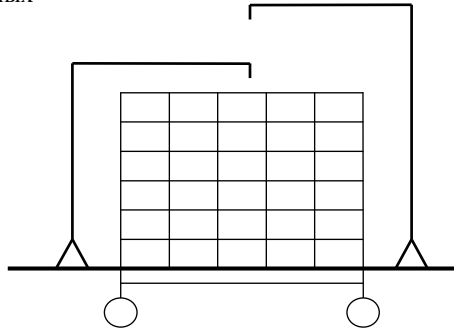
Схемы расположения монтажных кранов (стреловых, башенных)
